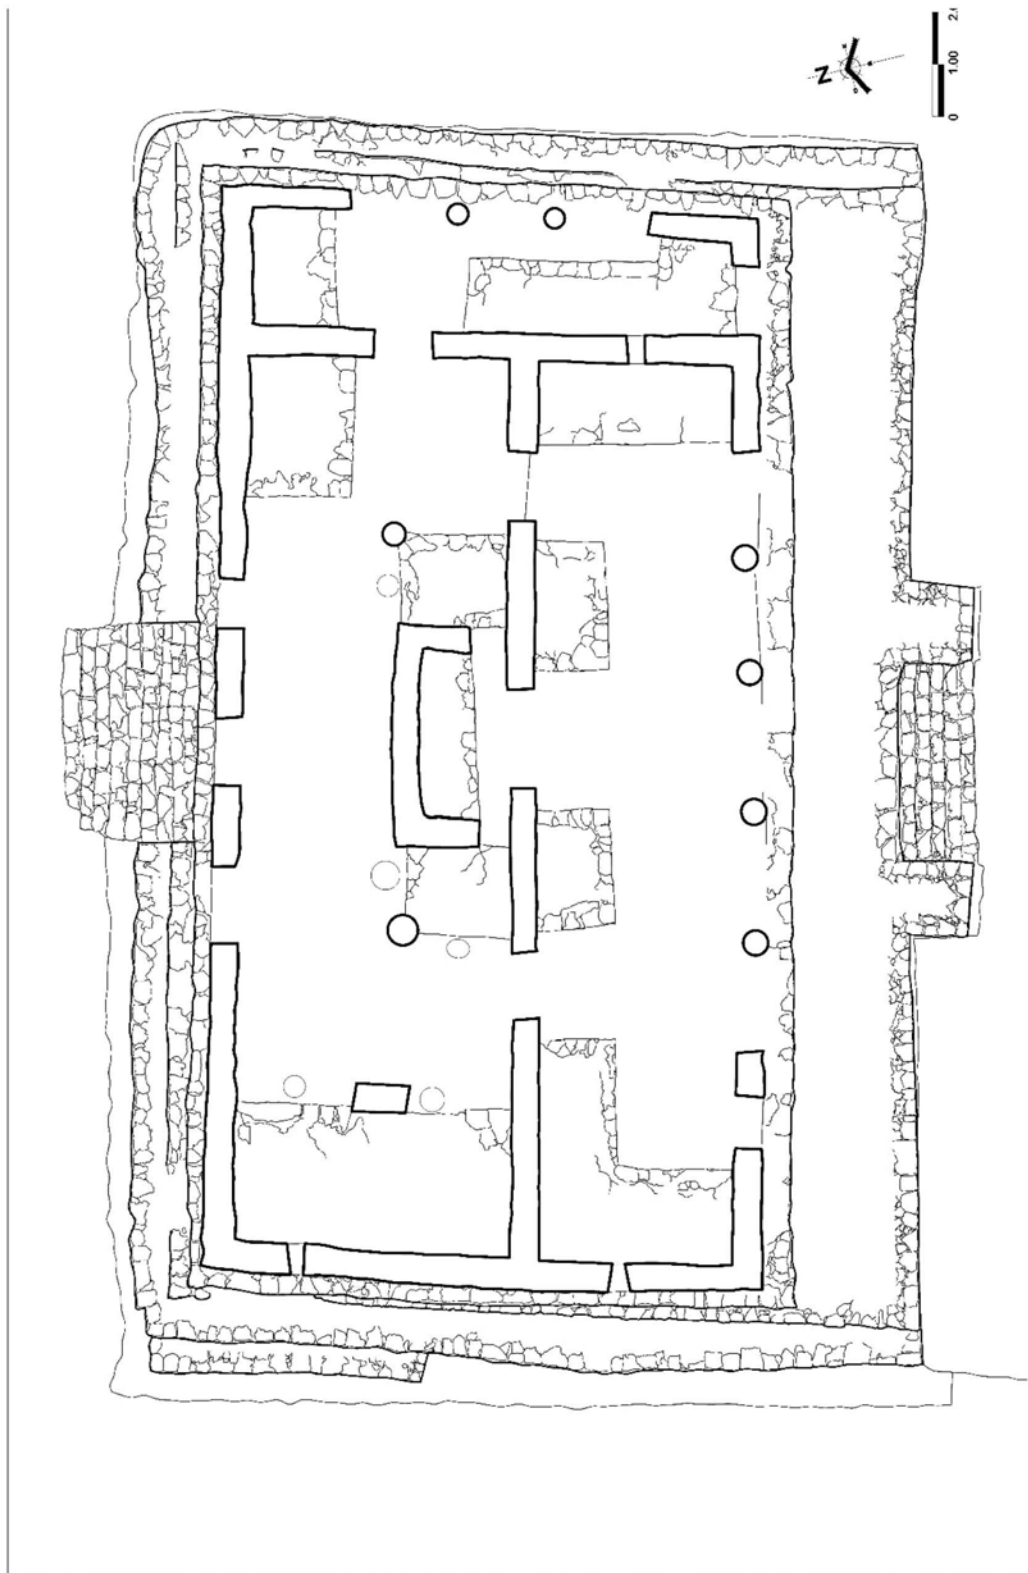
Planta arquitectónica con fábricas, Edificio 25, Tulum. R. Magdaleno, G. Nájera, 2014.
